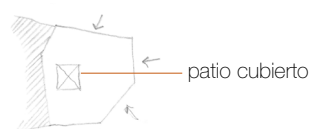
Boceto en planta del edificio ubicado en Avenida da Florida, 16 (autoría propia).
